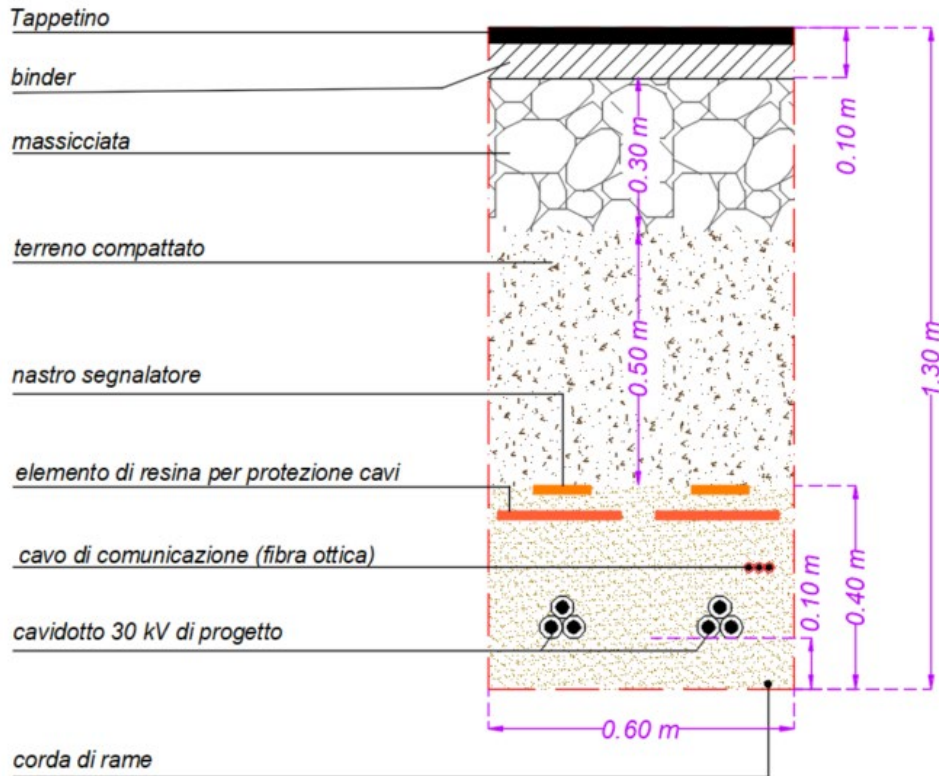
Sezione cavidotto doppia terna su asfalto.
